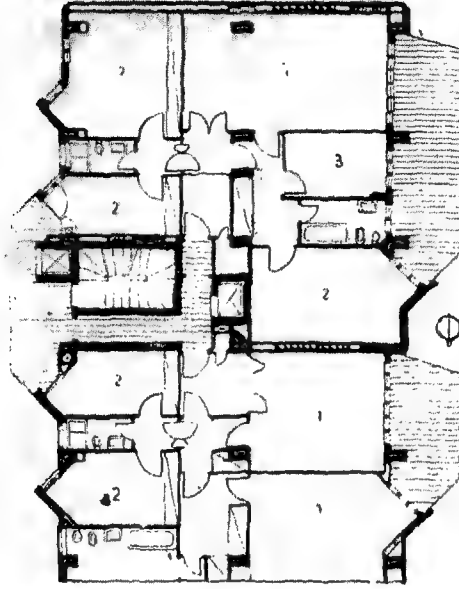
٣٥ - ٣ : مسقط أفقي الدور المتكرر ويتكون :
